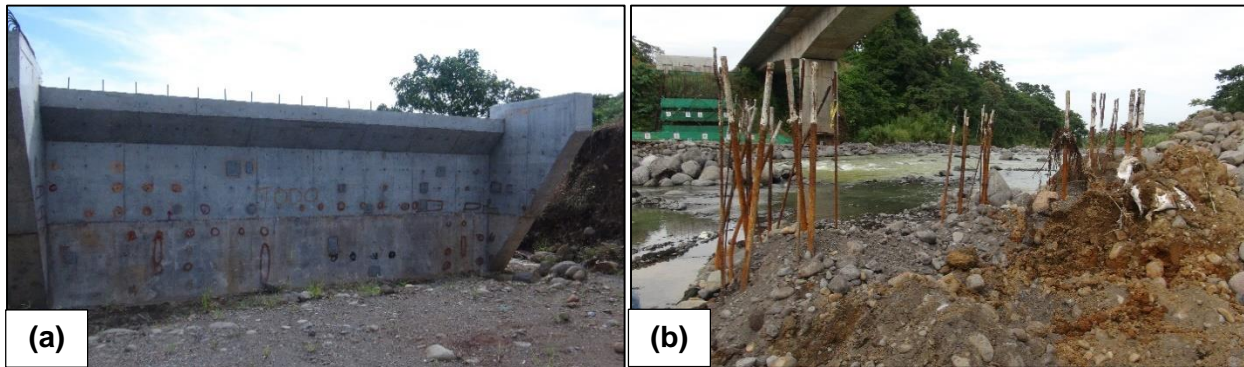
Avance en la construcción del puente sobre el Río Toro Amarillo. (a) Pilas 1 y 4 en construcción, al fondo el Bastión 1 construido. (b) Pila 5 en construcción, al fondo la Pila 6 construida.
